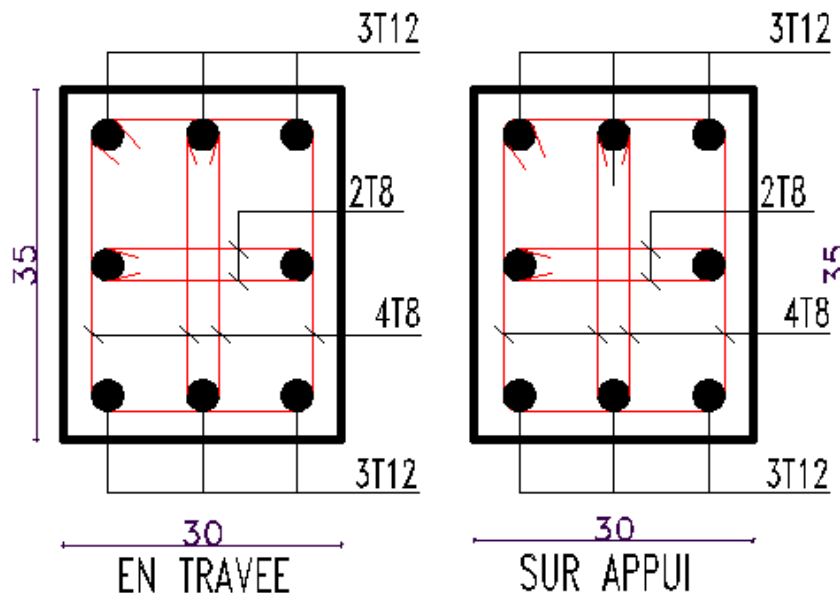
Schéma de ferrailage de la poutre palière en travée et sur appui.
